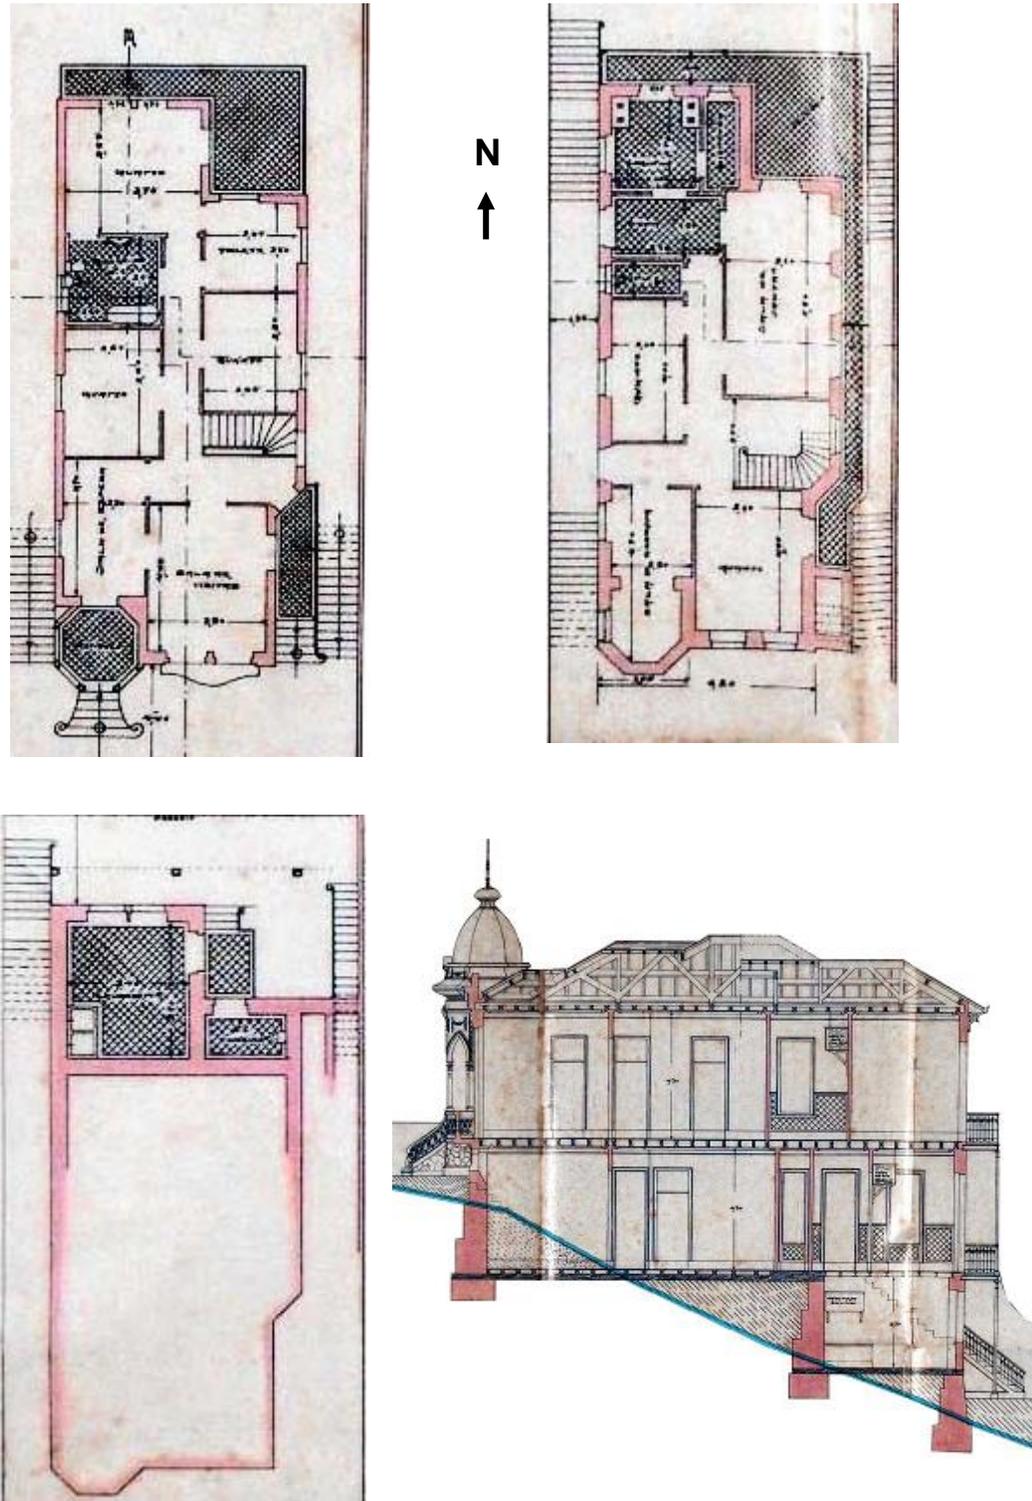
, 61, 62, 63: Acima, planta do pavimento de acesso e do pavimento inferior. Abaixo, Planta do porão e corte longitudinal.
